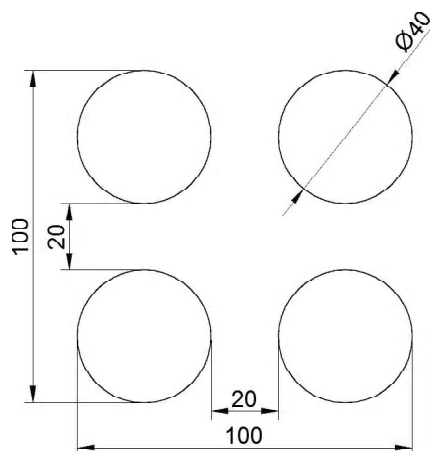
Компоновка группы вертикальных цилиндрических резервуаров.
